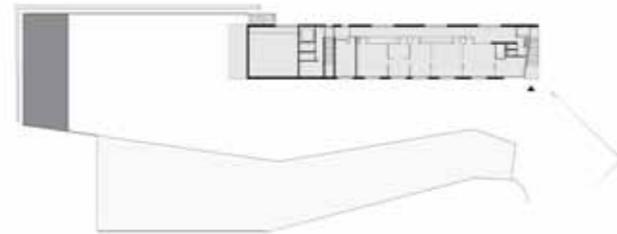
Forstwerkhof Biel - CH / Grundriss
